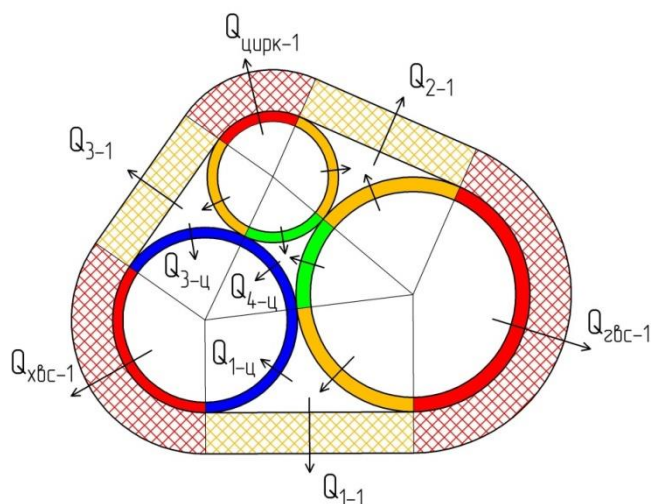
Расчетная схема пучка трубопроводов; трубопроводы:
